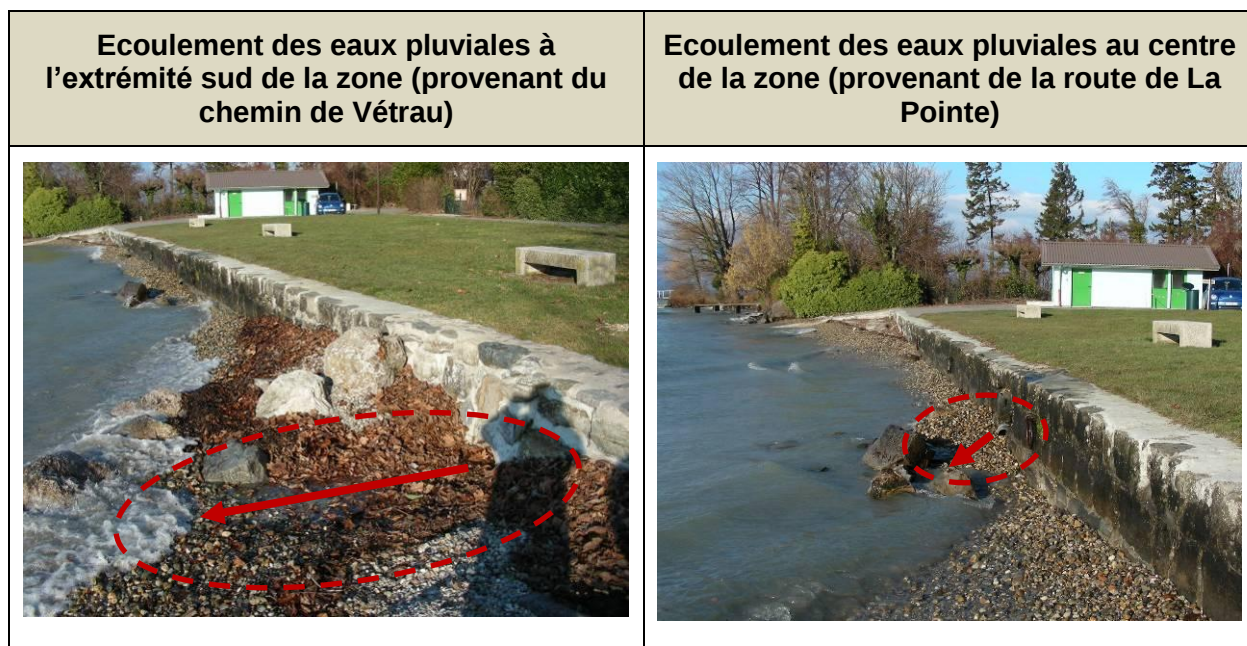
Ecoulement d'eaux pluviales sur la zone de baignade
